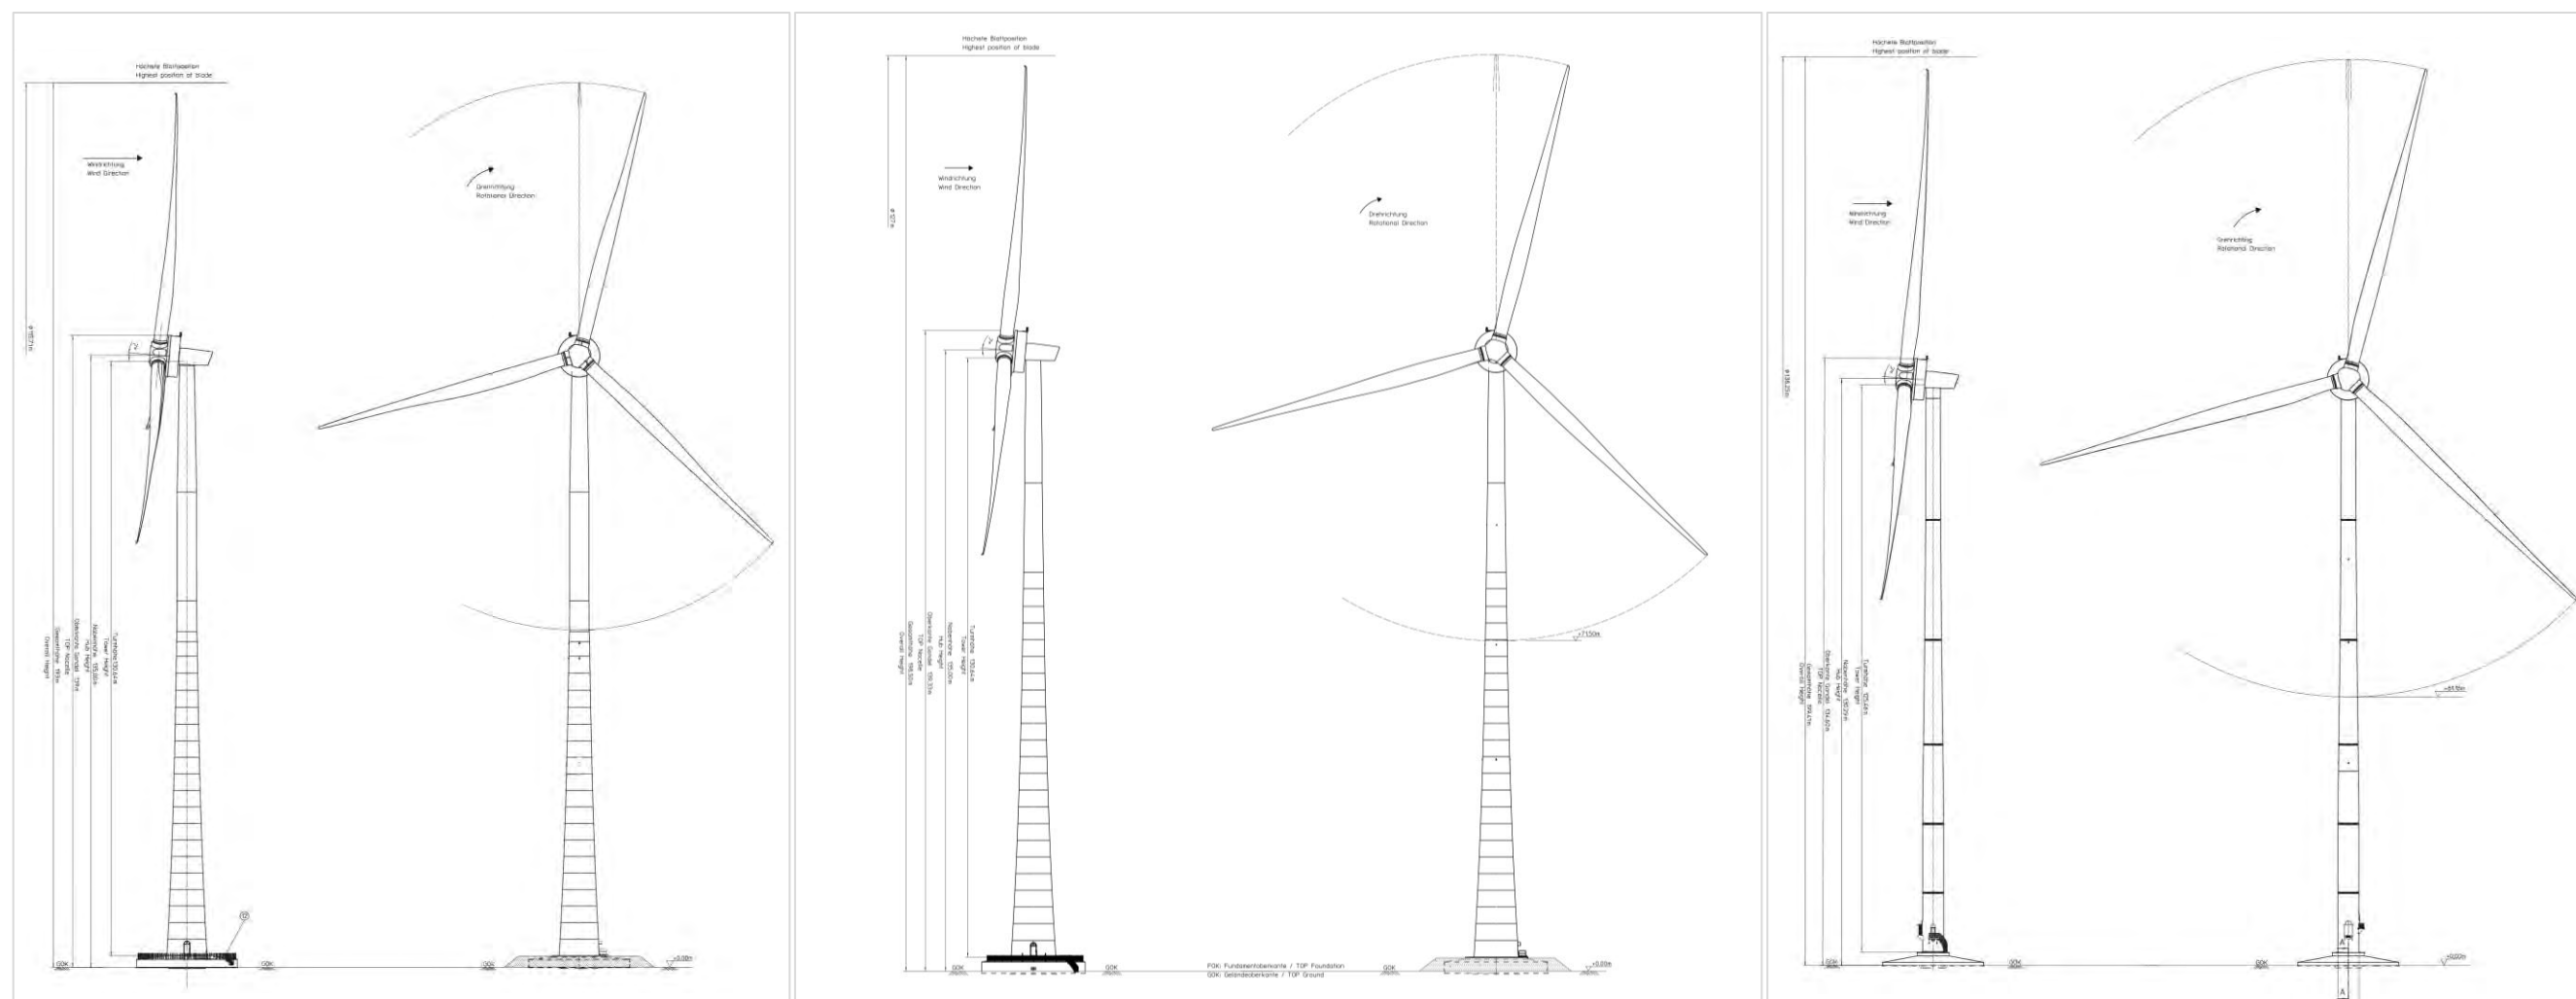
Plans de façade de l'éolienne E115 (à gauche), E126 (au centre) et E138 (à droite)
